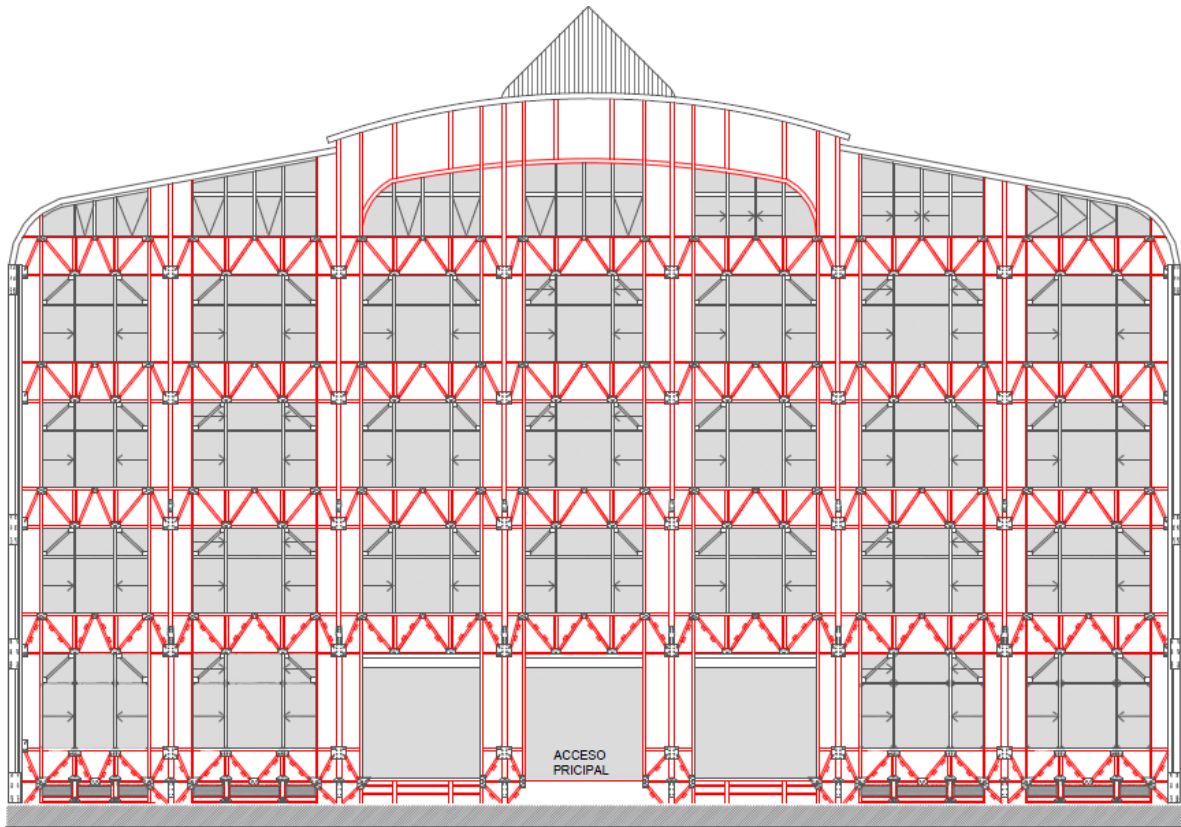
Fachada oriente de la facultad de ingeniería de la universidad de Valparaíso.
